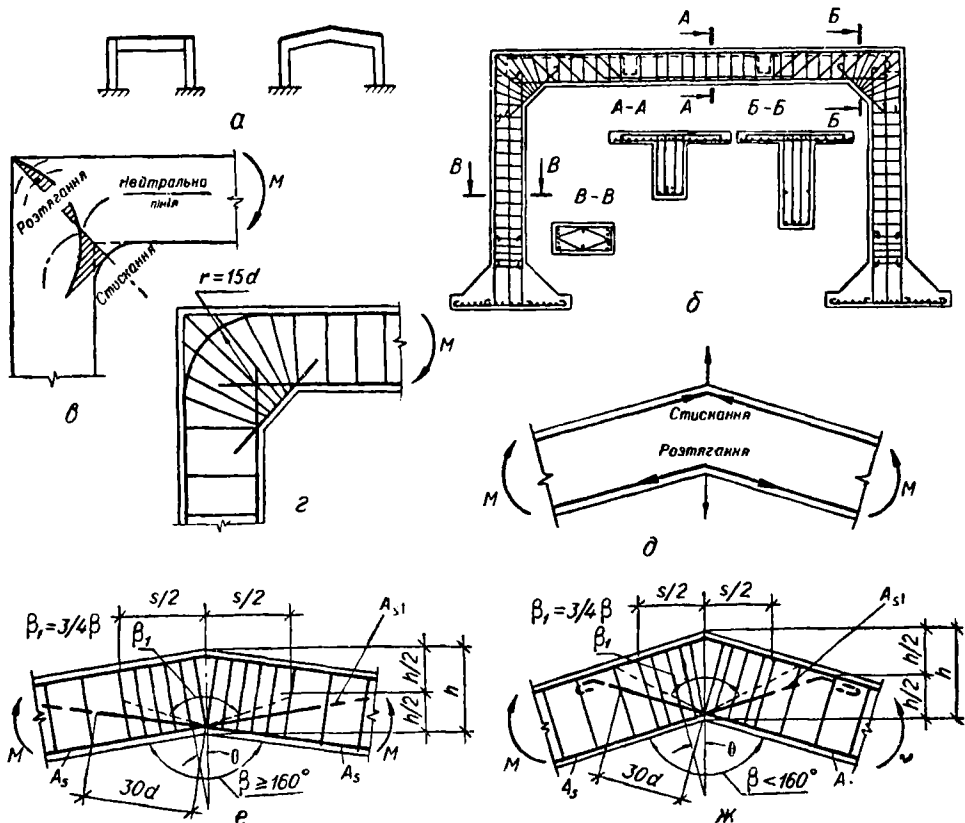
Поперечні рами з монолітного залізобетону:
